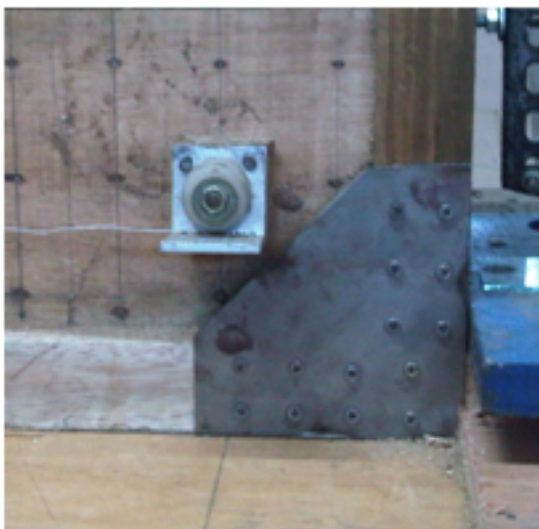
Prototip dinding geser papan kayu silang laminasi-paku
